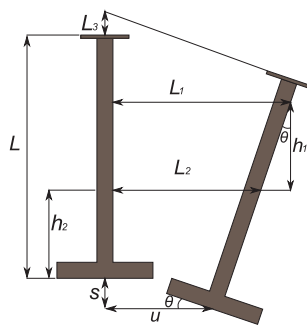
Schémas du calcul des déplacements du point central sur la base de la fondation
